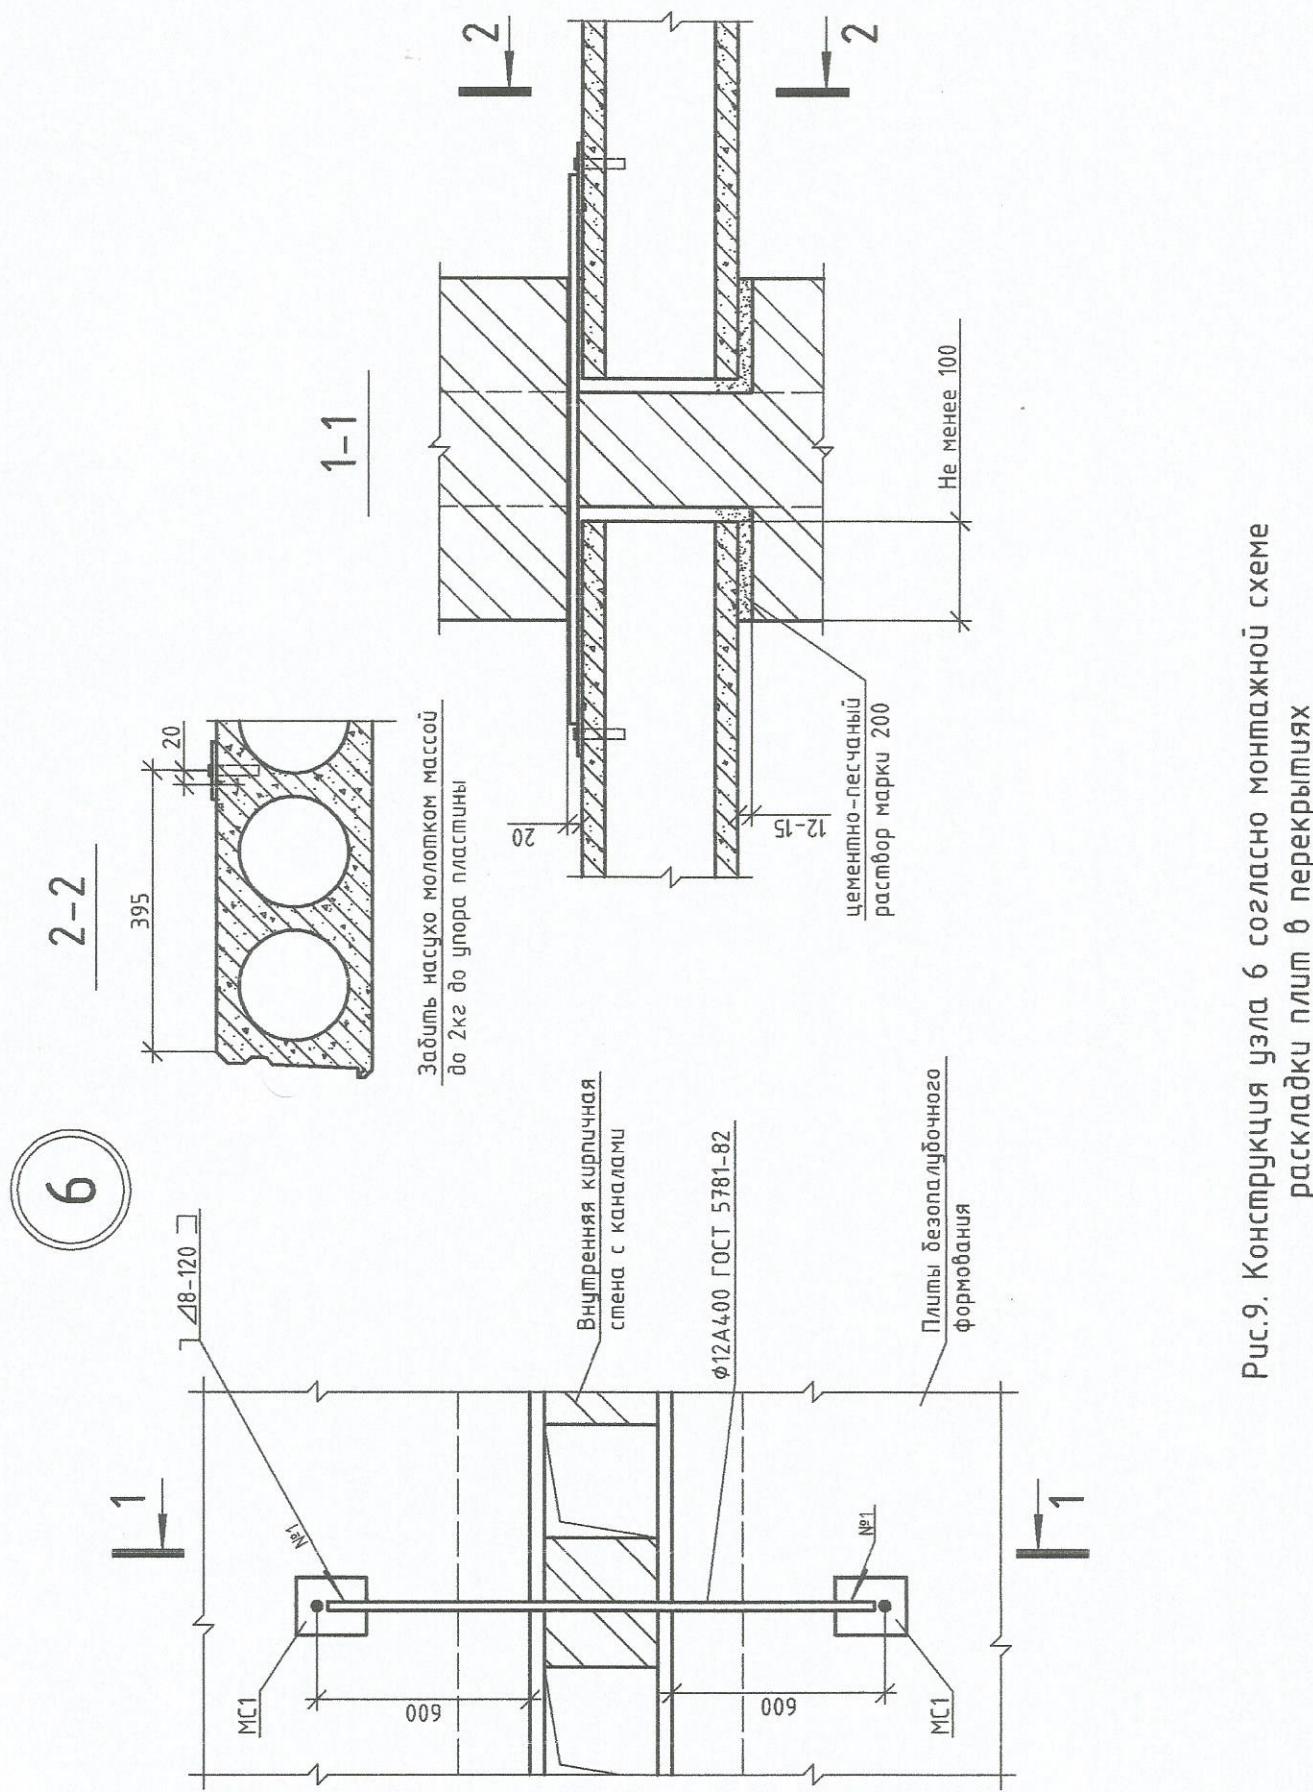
Конструкция узла 6 согласно монтажной схеме раскладки плит в перекрытиях
